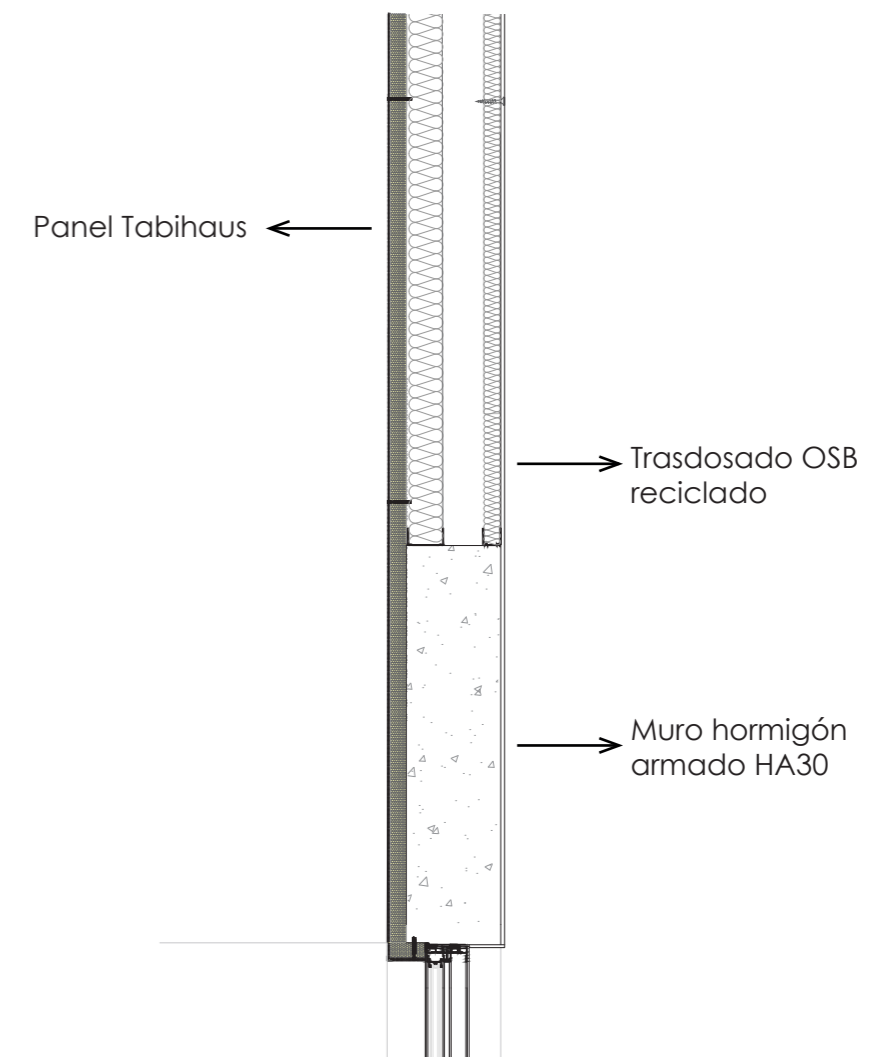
Detalle de del aula emergiendo sobre los muros de hormigón armado del edificio
